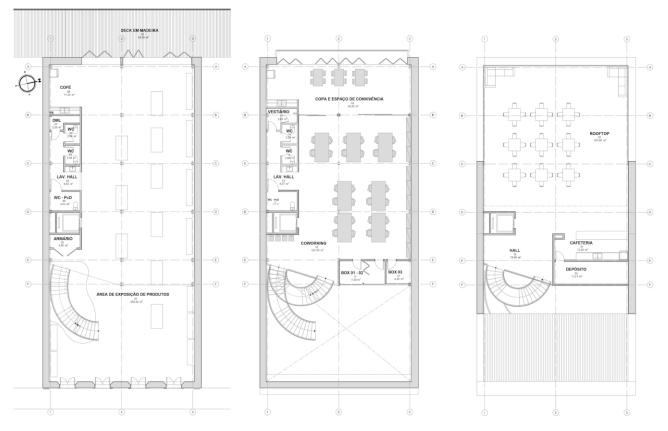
Planta Baixa, Pav. Térreo, Superior e Rooftop.
